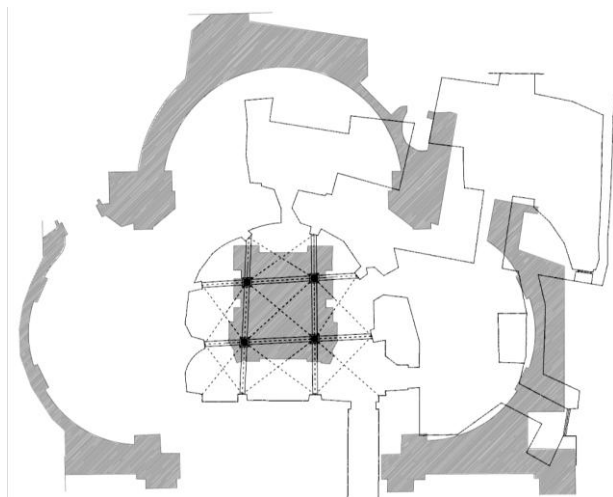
Planimetria: sovrapposizione tra cripta e santuario
